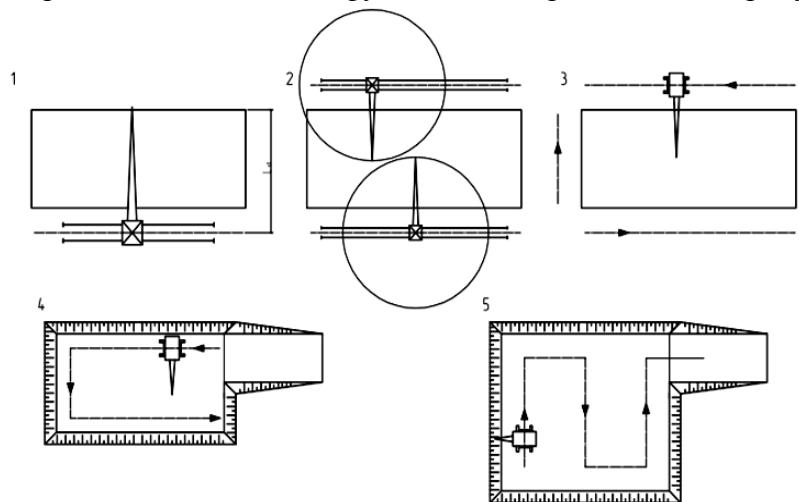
Схема устройства фундаментов многоэтажного здания: по первой и второй схемам фундаменты монтируют башенными кранами или кранами-нулевиками; по третьей, четвертой и пятой схемам фундаменты монтируют самоходными стреловыми кранами
